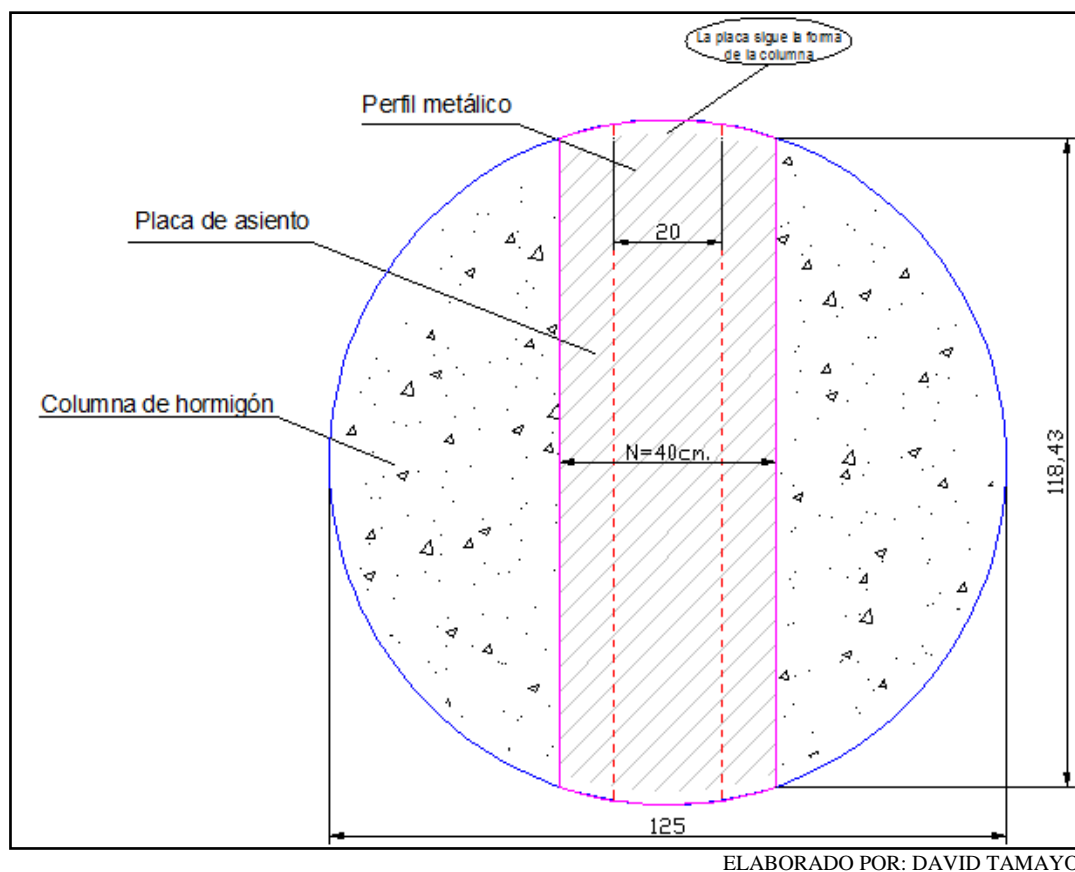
(Dimensiones finales de la placa de asiento para el apoyo 1)
